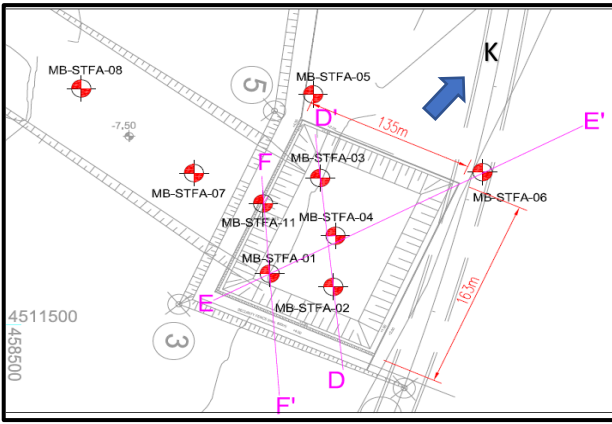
Kuru havuz planı ve palplanş deneme çakımı
